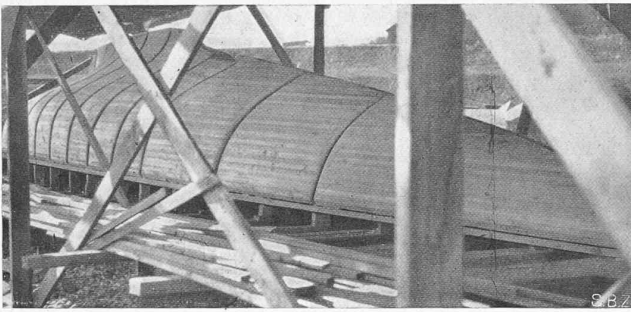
Hölzerne Schalung vor dem Betonieren.
